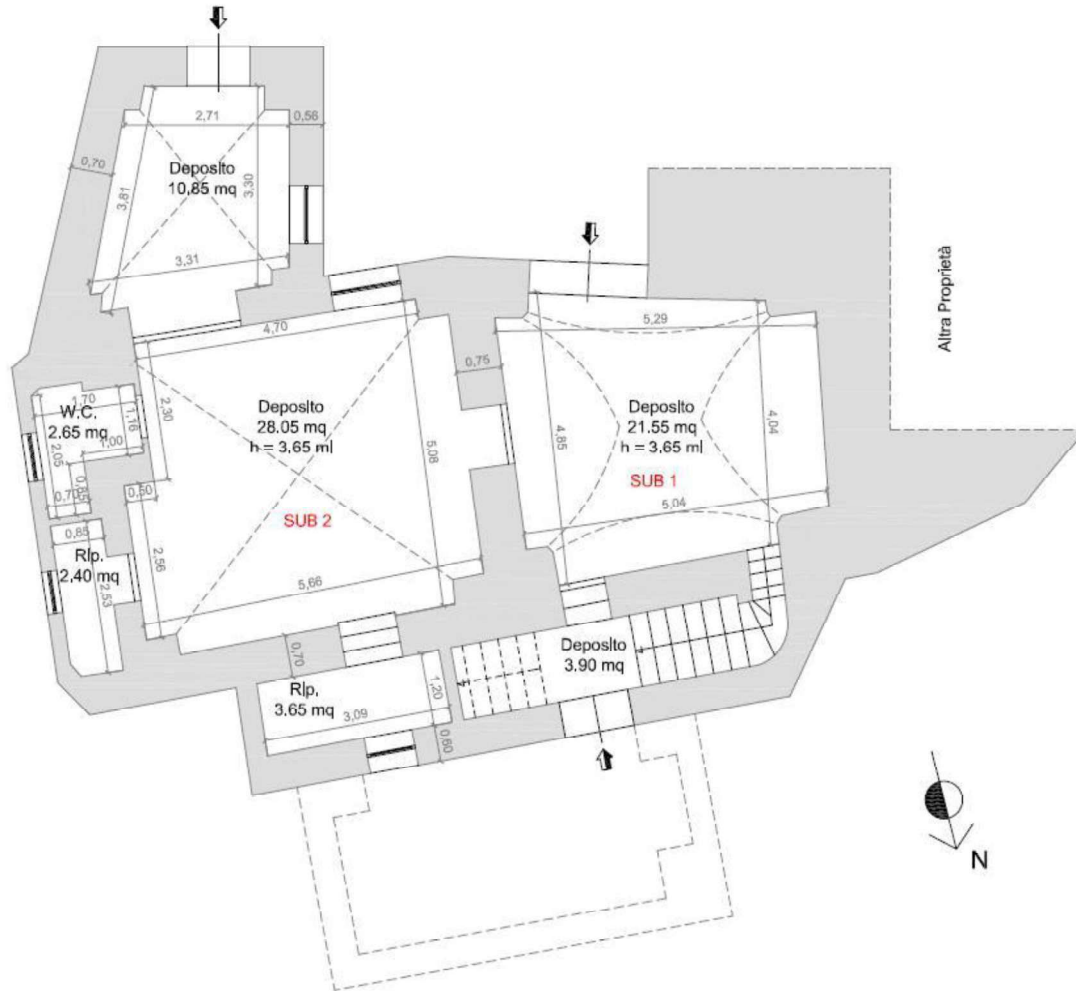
Planimetria Stato di Fatto Immobile, Piano T, Foglio 35, p.lla 817, Sub 1-2.
